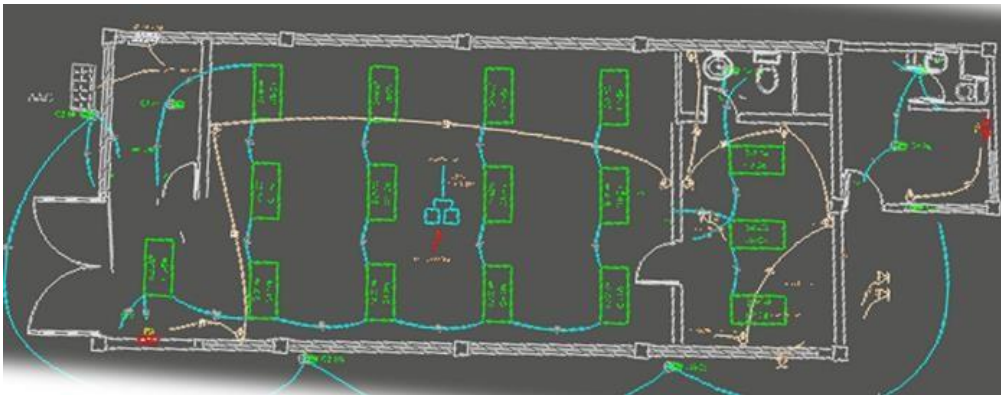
Diseño de sistema eléctrico planta baja área de producción Fuente: Autor
